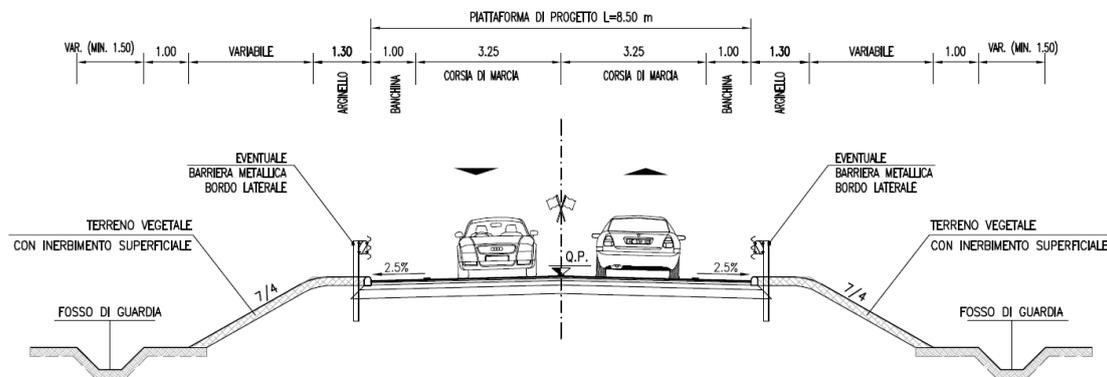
Sezione tipo in rilevato – Cat. F2 extraurbana locale
